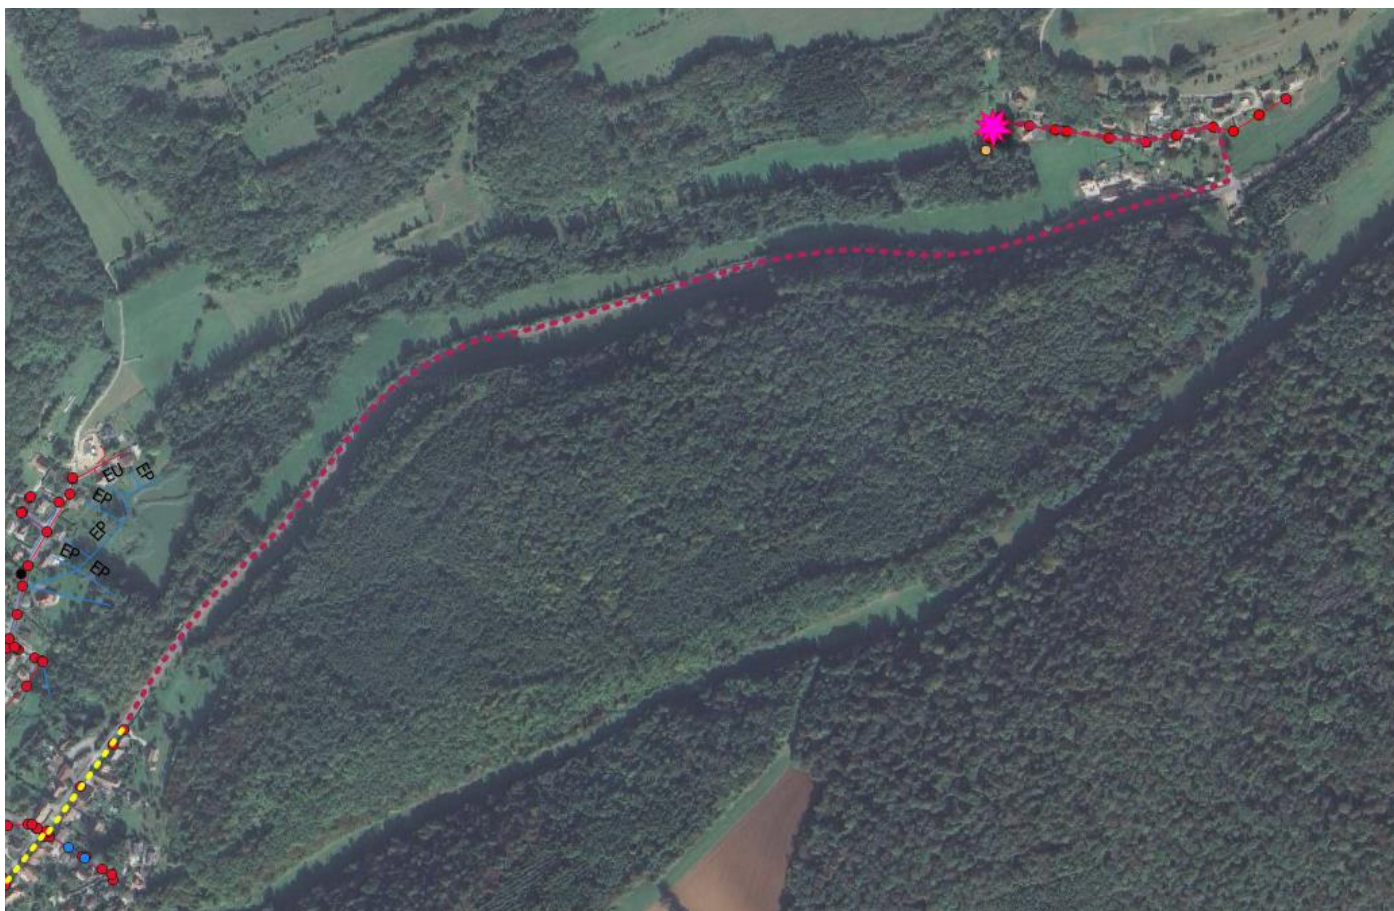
Variante 2 : Création d'une conduite de refoulement le long de la voirie
